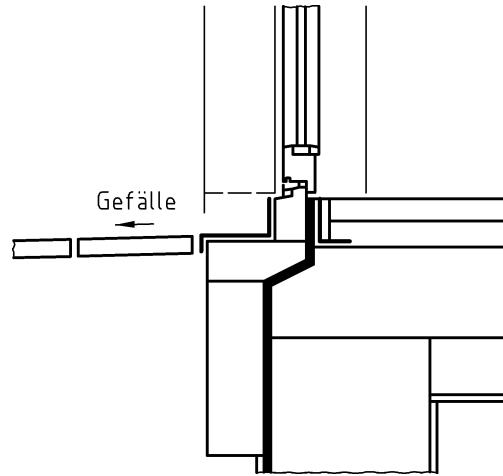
Sockel; hinterlüftete Verblendschale, Entwässerung über OK Gelände
